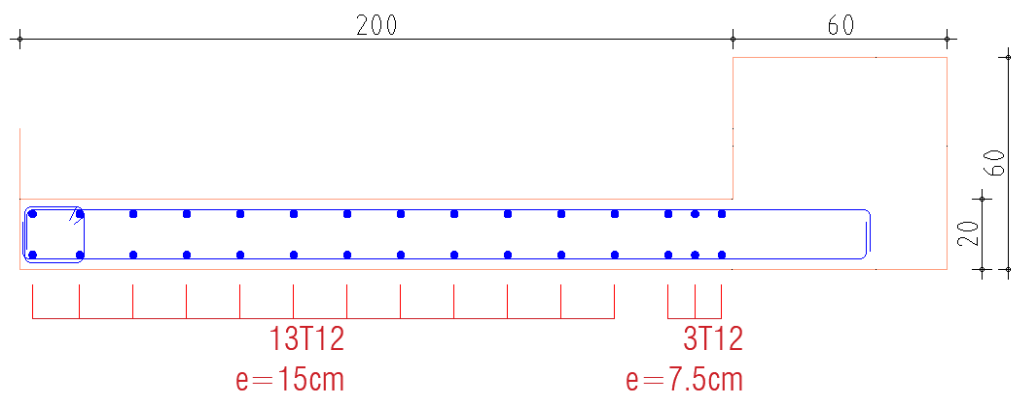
Ferrailage du voile Vx1 Zone 1
